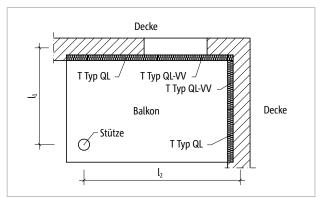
Schöck Isokorb® T Typ QL, QL-VV: Balkon zweiseitig aufliegend mit
